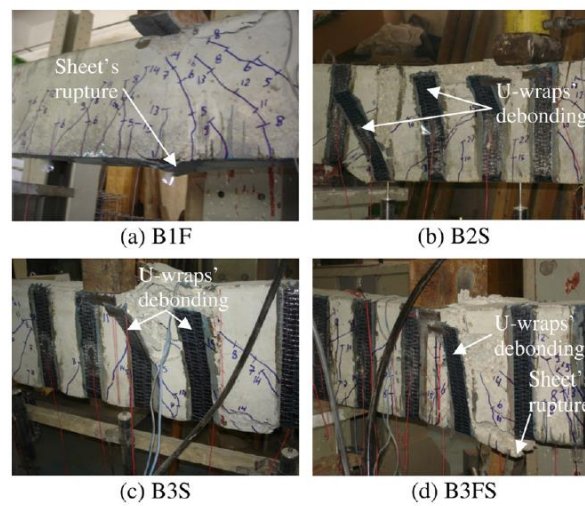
Acercamiento a las fallas de todas las vigas reforzadas.
